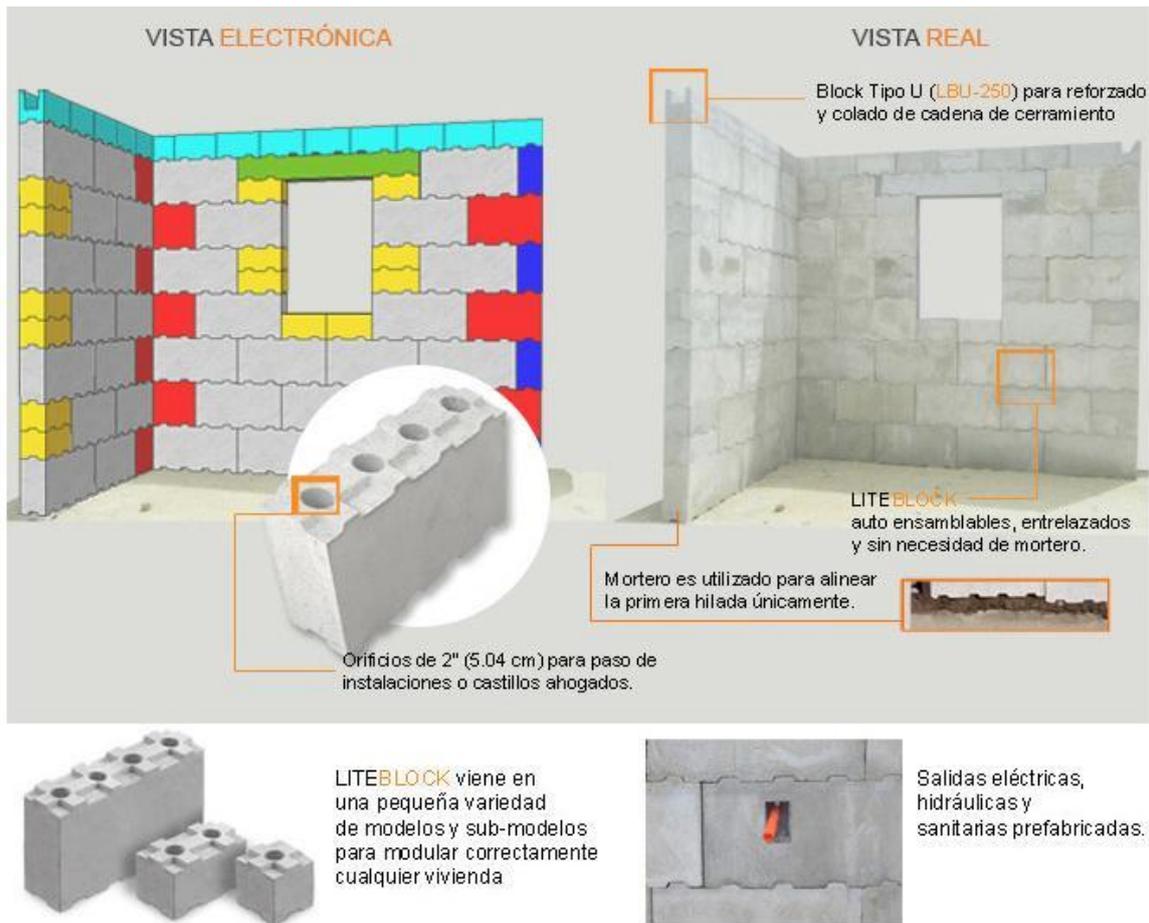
Sistema constructivo LITEBLOCK. Imagen: <http://www.litebuilt.com.mx/>
